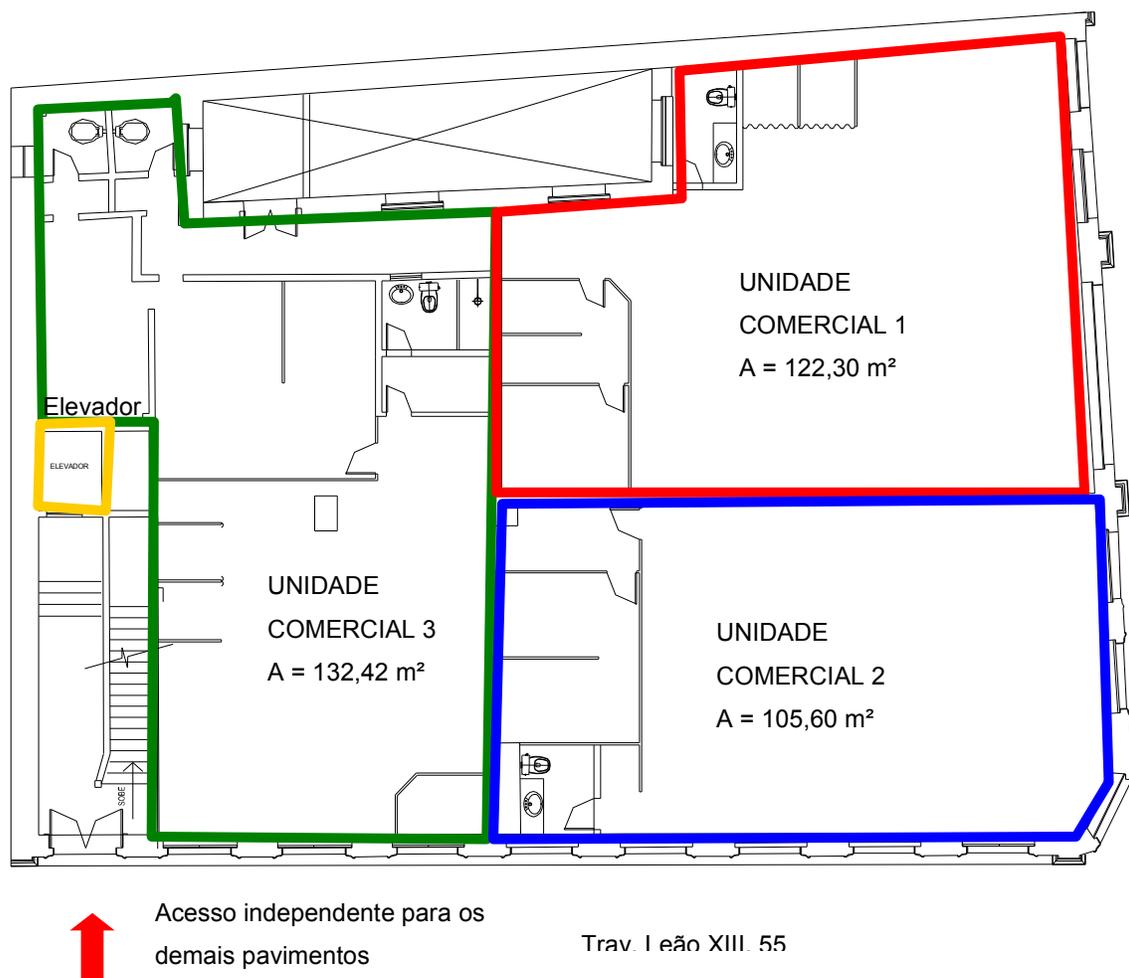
Planta baixa da proposta do pavimento térreo do imóvel da Trav. Leão XIII, N° 55/Rua Santo Antônio 139/153.
